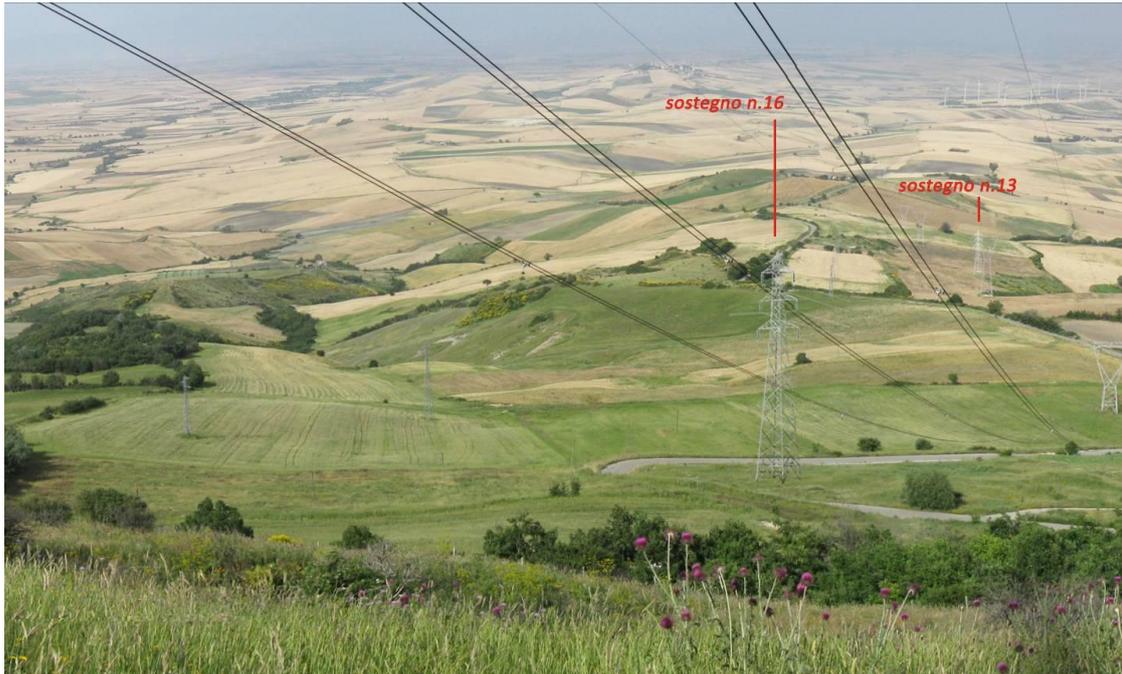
Il sostegno 16 (in primo piano) ed il 13 (sullo sfondo) si raccordano alla strada esistente con brevi tratti di piasta in piano
